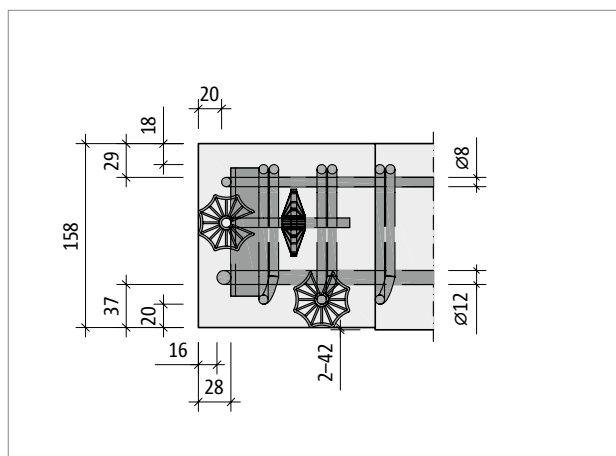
Tronsole® Z: Seitenansicht einer Auflagerkonsole mit eingebautem Tragelement T-V1
